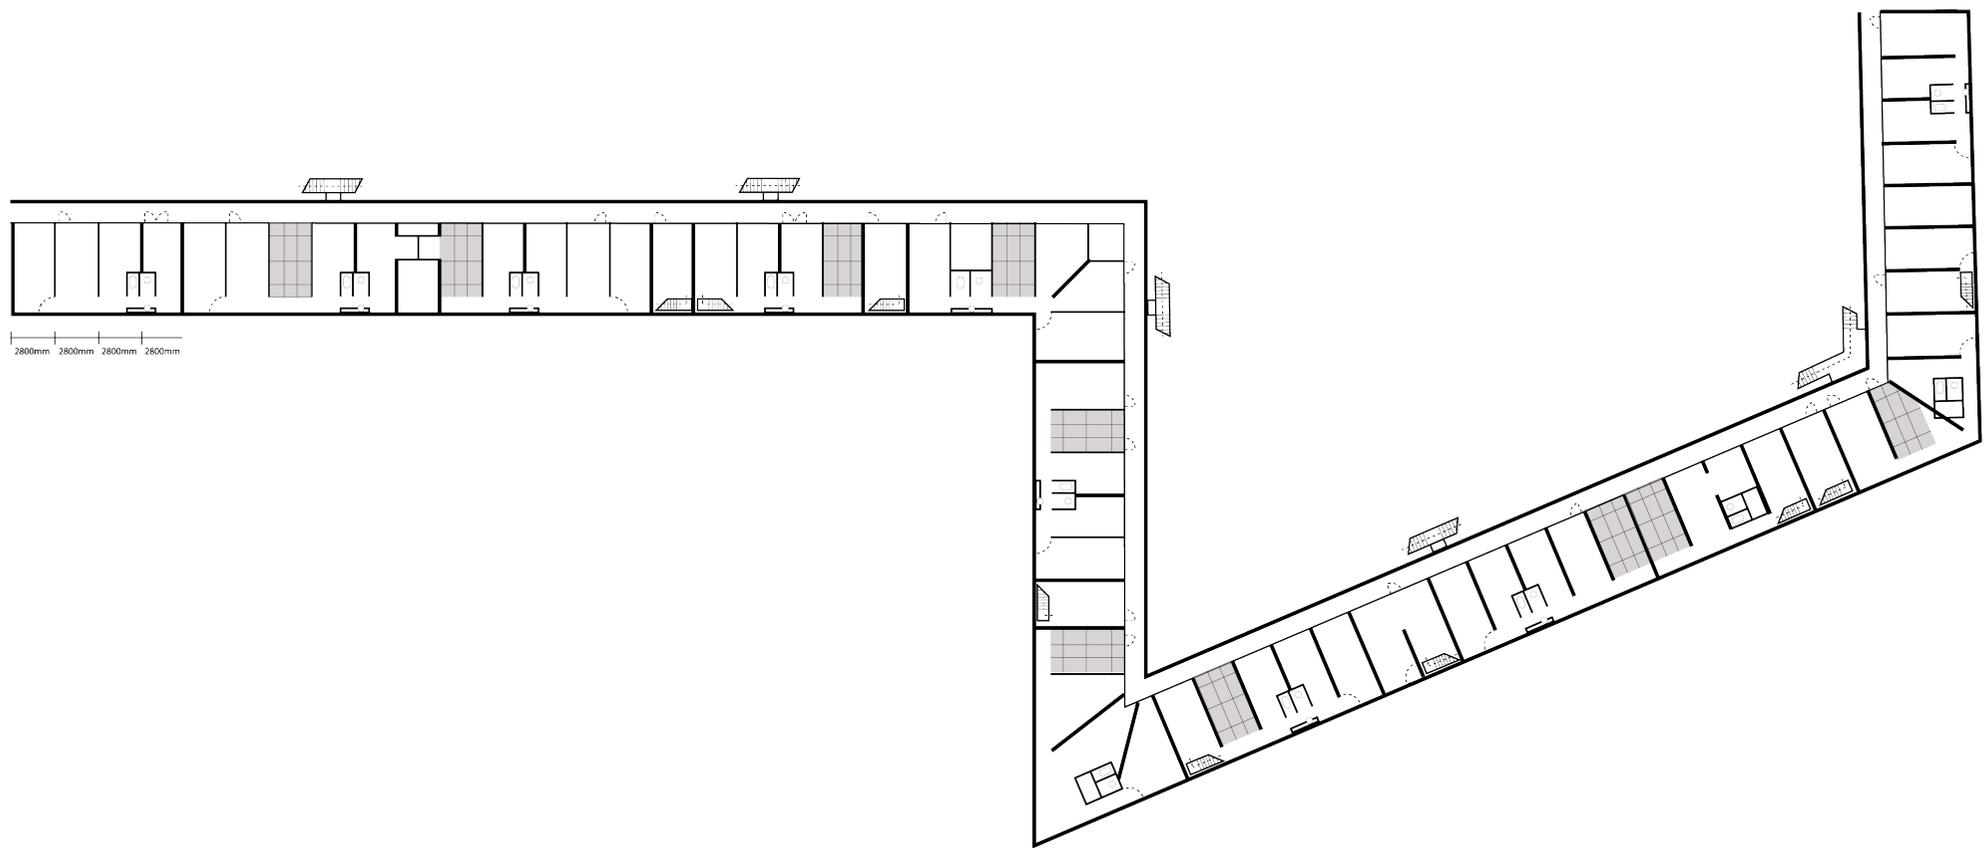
Exemplo de planta (pavimento 8) do *complexo habitacional Gifu Kitagata
